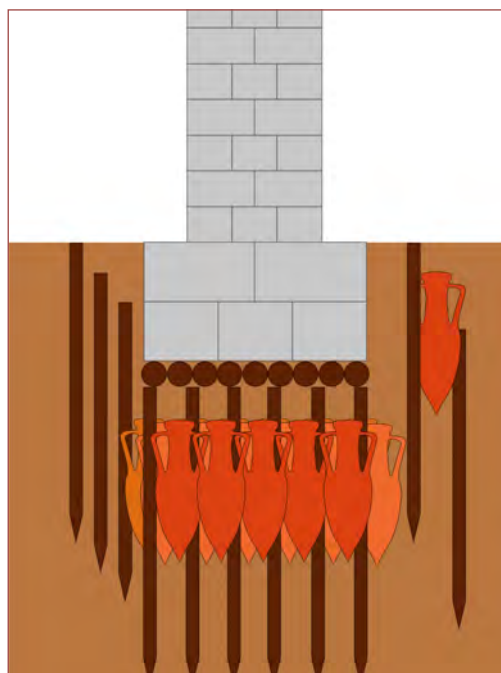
Ricostruzione del sistema di consolidamento del terreno funzionale alla costruzione della cinta esterna (disegno di M. Zuccotto).
